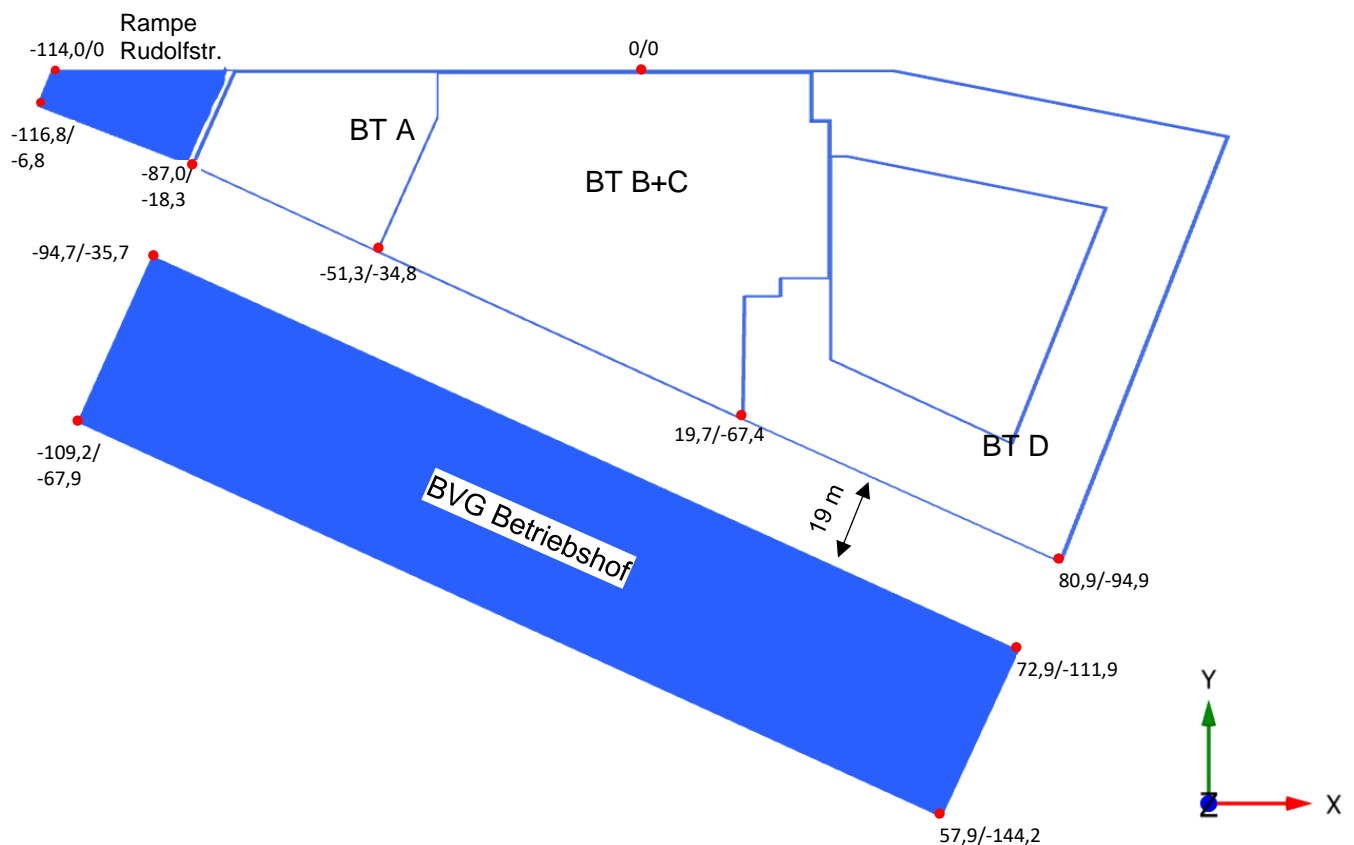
Lage des BVG-Betriebshofs und der Rampe Rudolfstraße im FE-Modell – Grundriss
